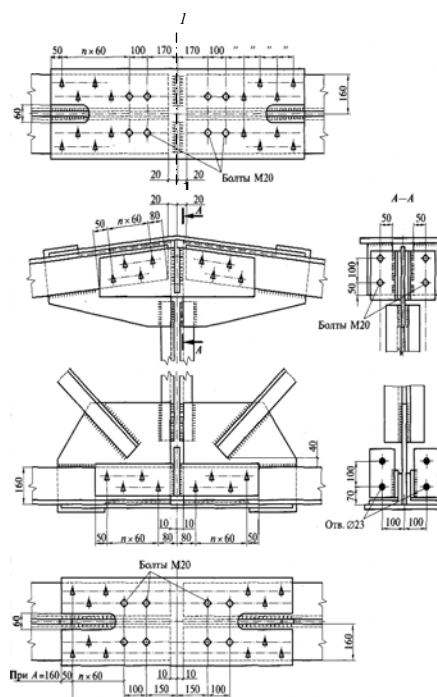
Укрупнительный стык стропильной фермы из парных уголков на высокопрочных болтах
